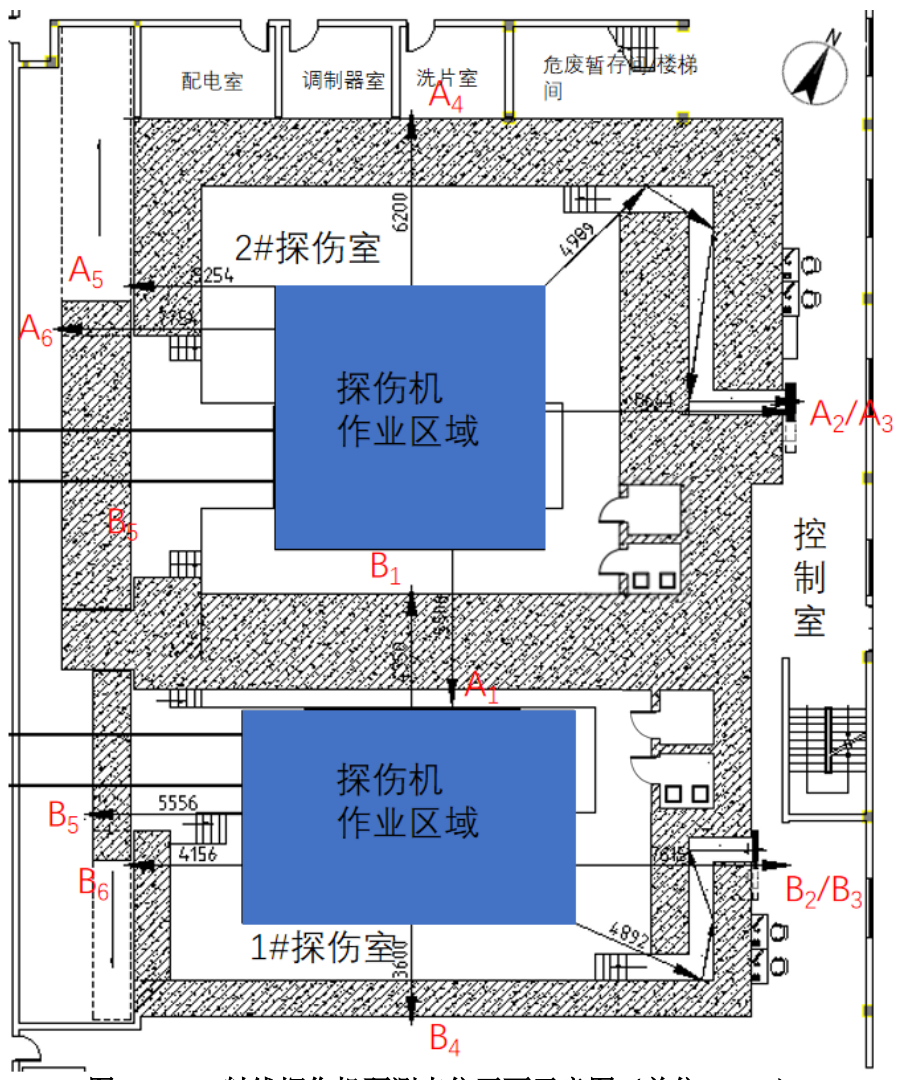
γ 射线探伤机预测点位平面示意图 (单位: mm)
